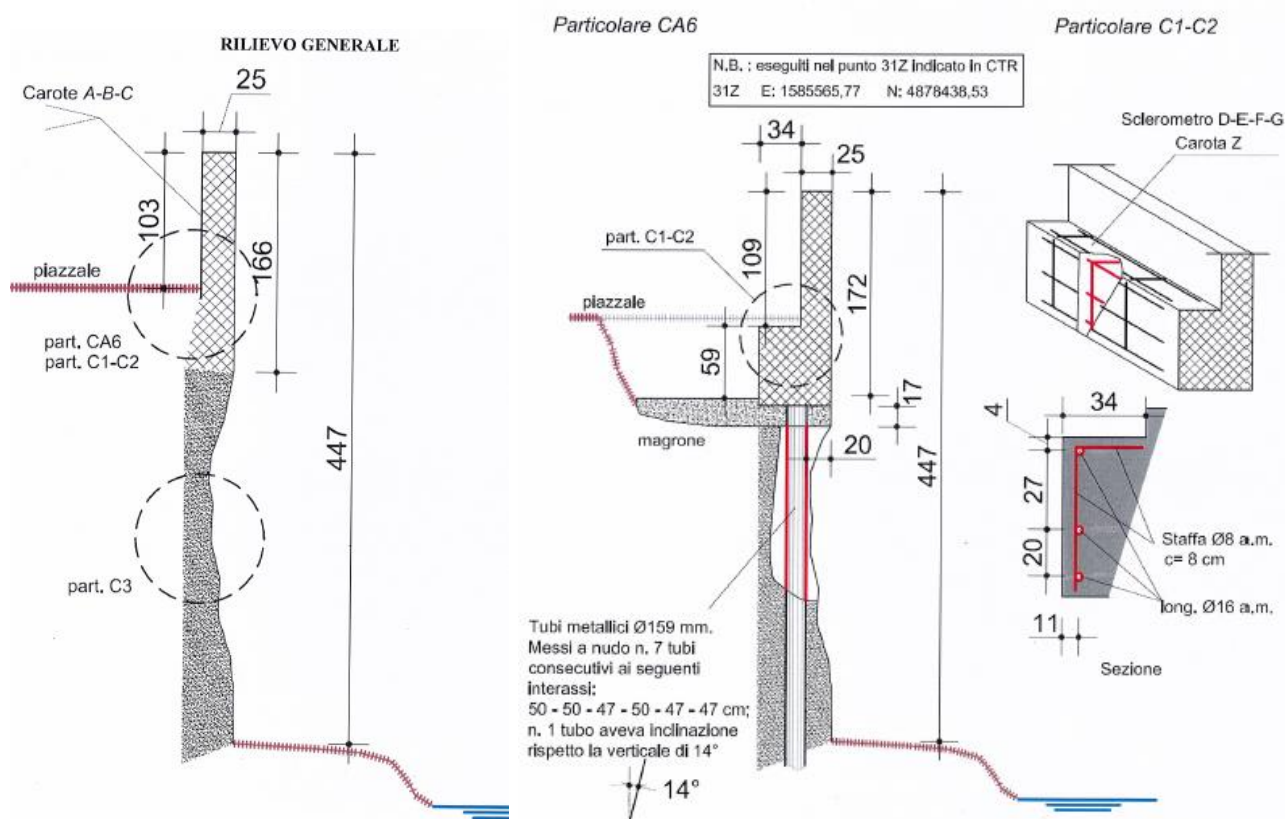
Sezione tipologica strutturale rilevata in sito
